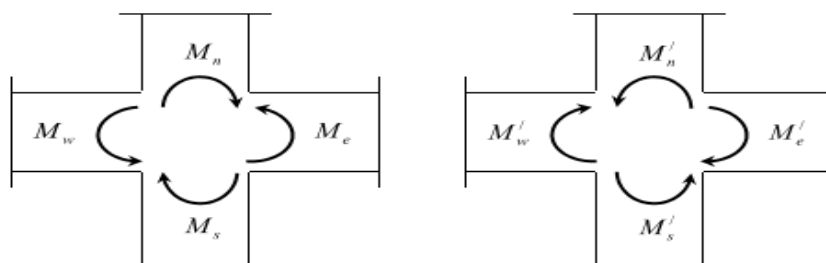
dimensionnement d'un nœud poutre – poteau [33].
